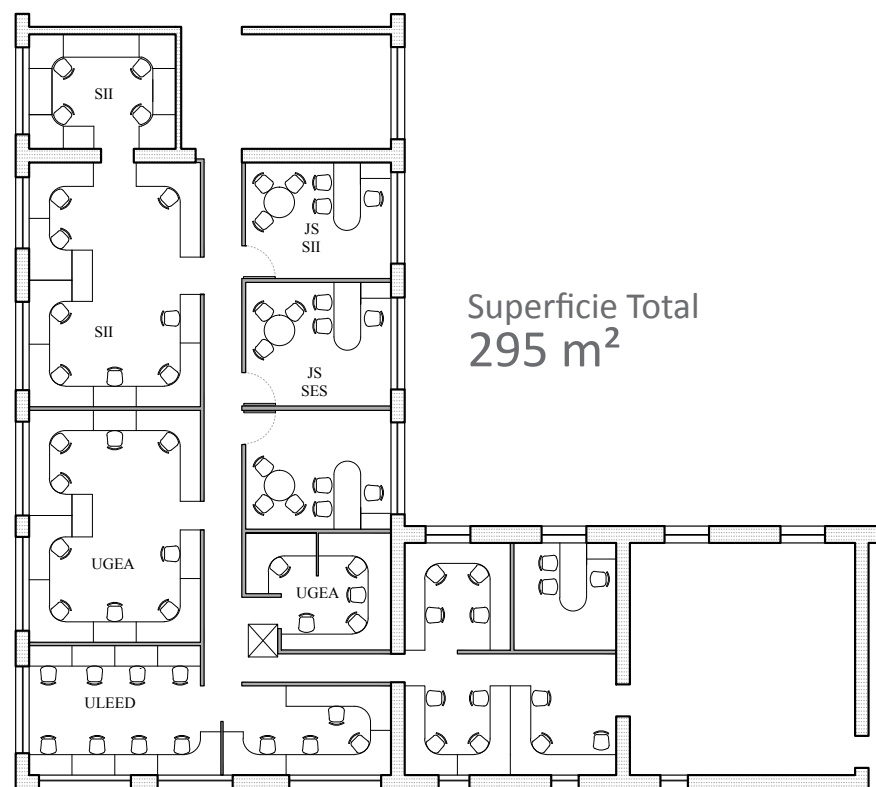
Planta de oficinas de la Sección Energía y Sustentabilidad
